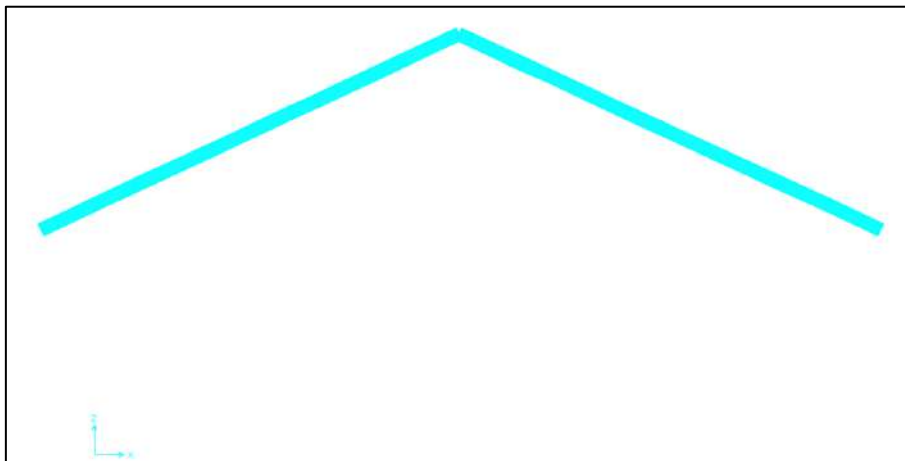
Labels de elementos tipo Frame, vigas del techo.
